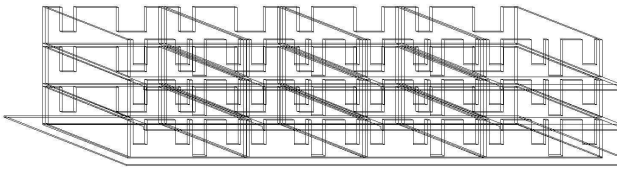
Pasos del proceso constructivo con prefabricados estructurales.
